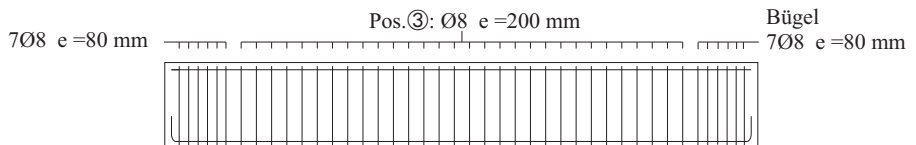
Balkentyp B19 - Bewehrungsplan
